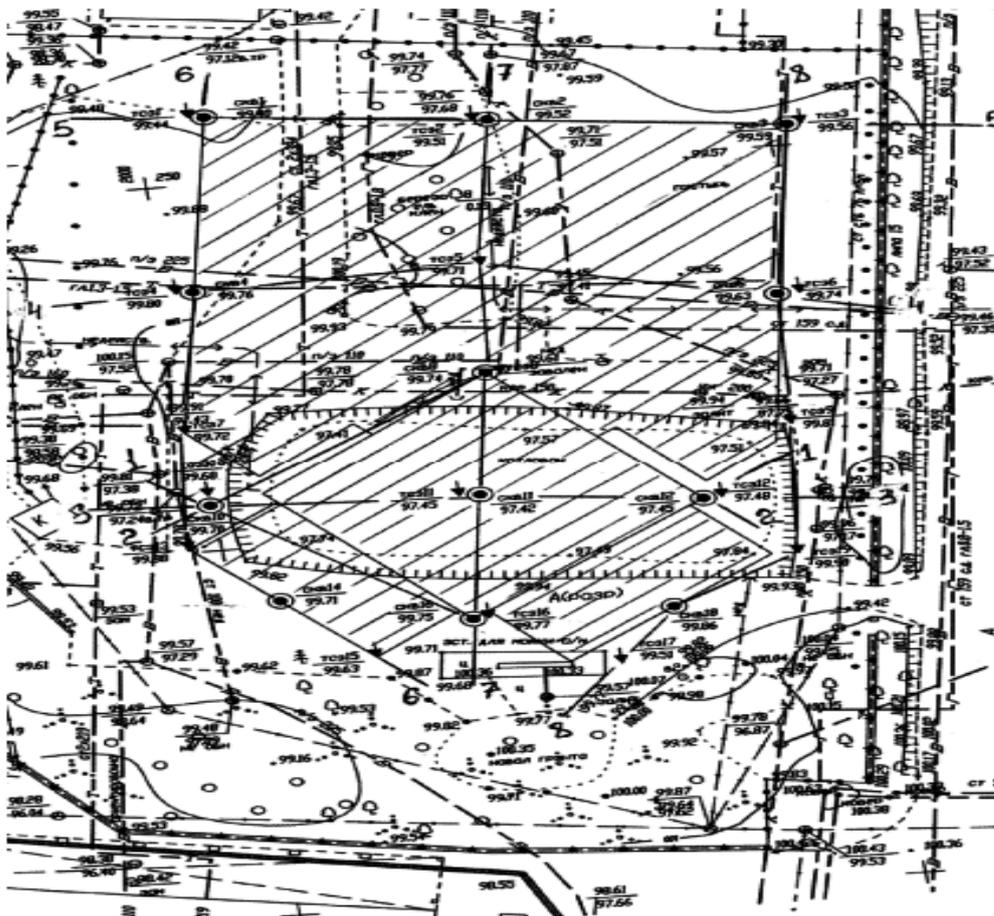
Схема плана строительной площадки с нанесенными инженерно-геологическими выработками и разрезами
